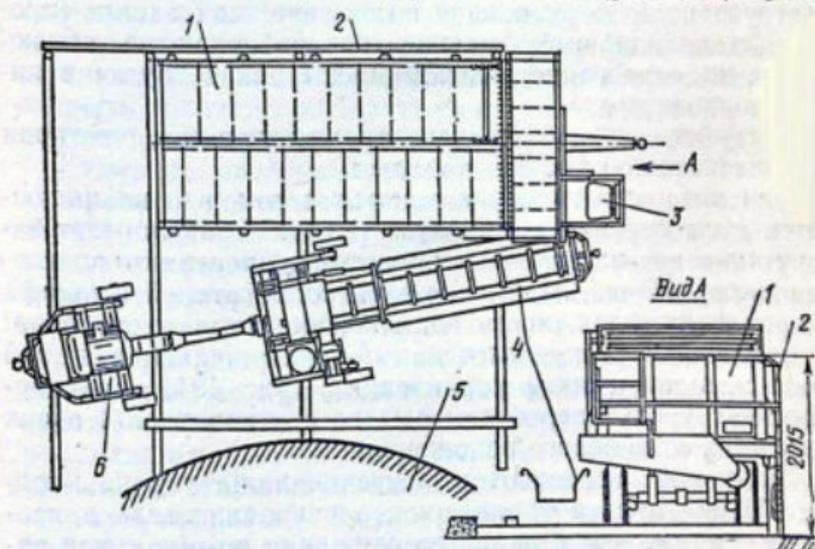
Схема размещения оборудования для загрузки сенажной башни:
